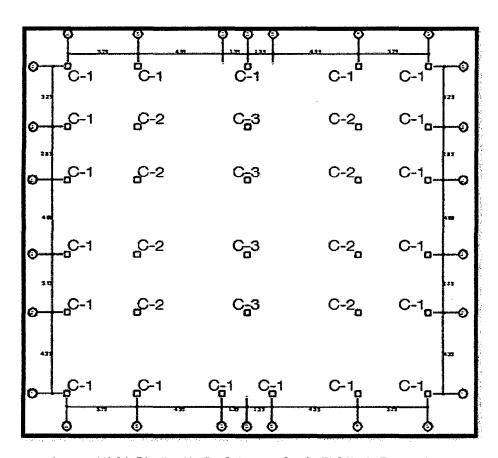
Distribución De Columnas Según El Cálculo Realizado
